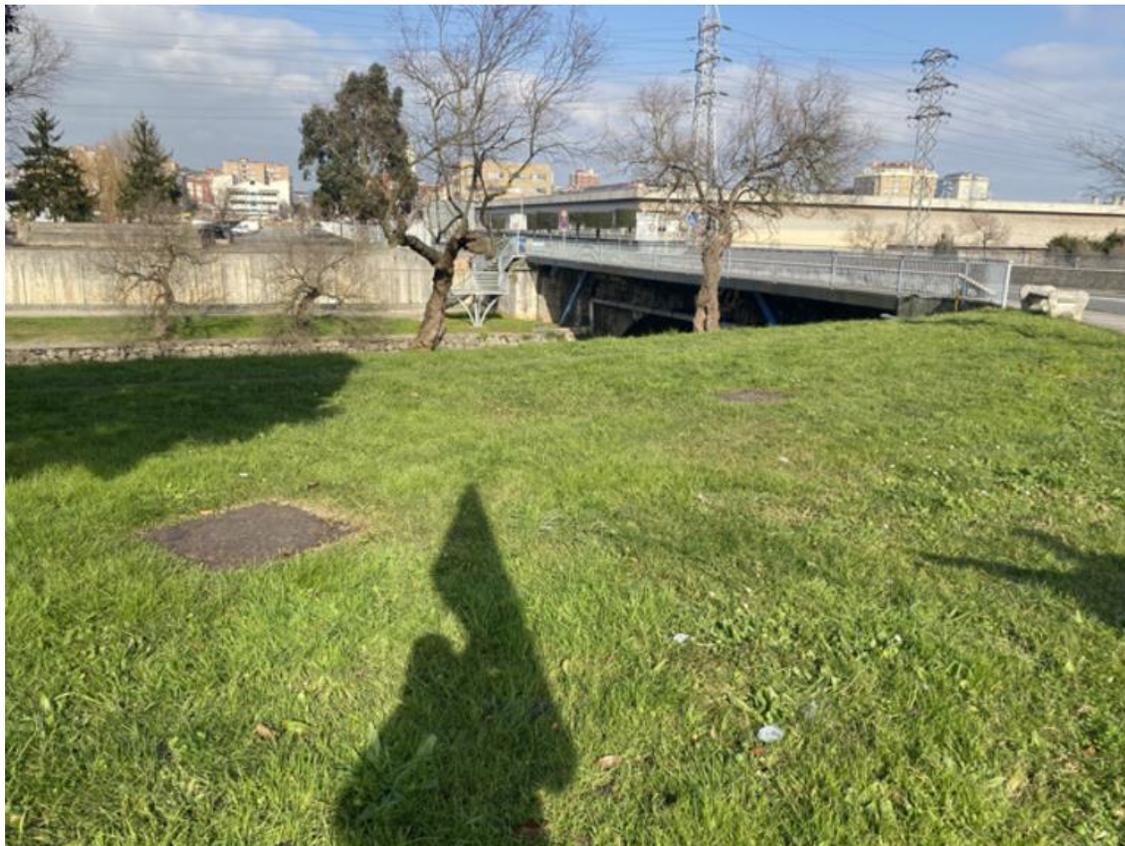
Detalle de la zona adyacente al puente donde se ubican las dos tapas de registro
